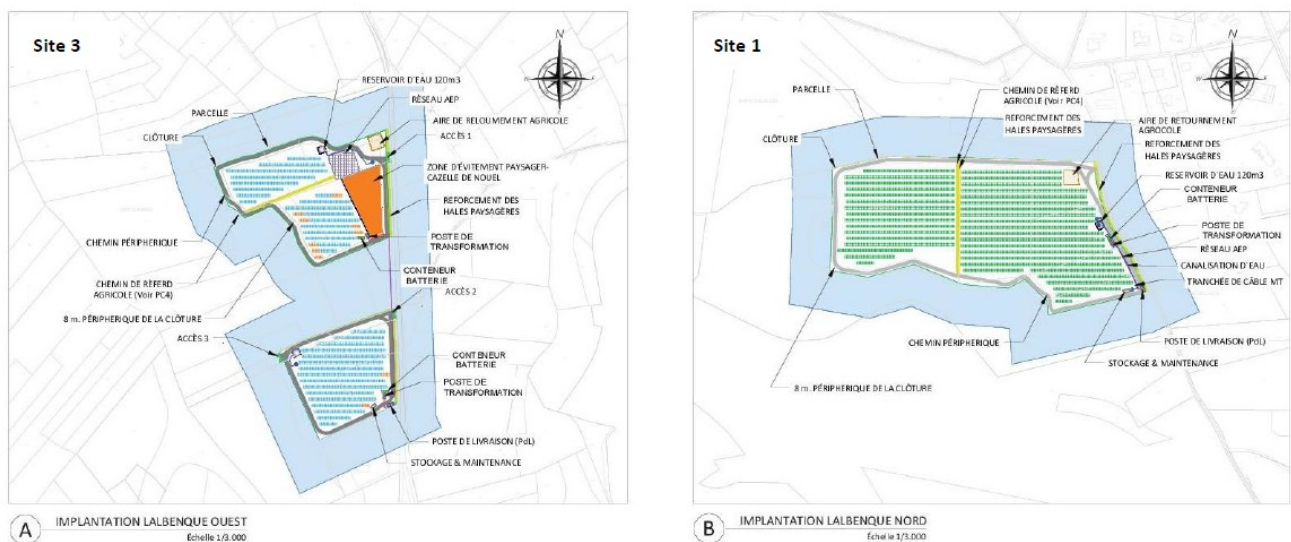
plan de masse des sites 3 (à gauche) et 1 (à droite) (source : étude d'impact)
